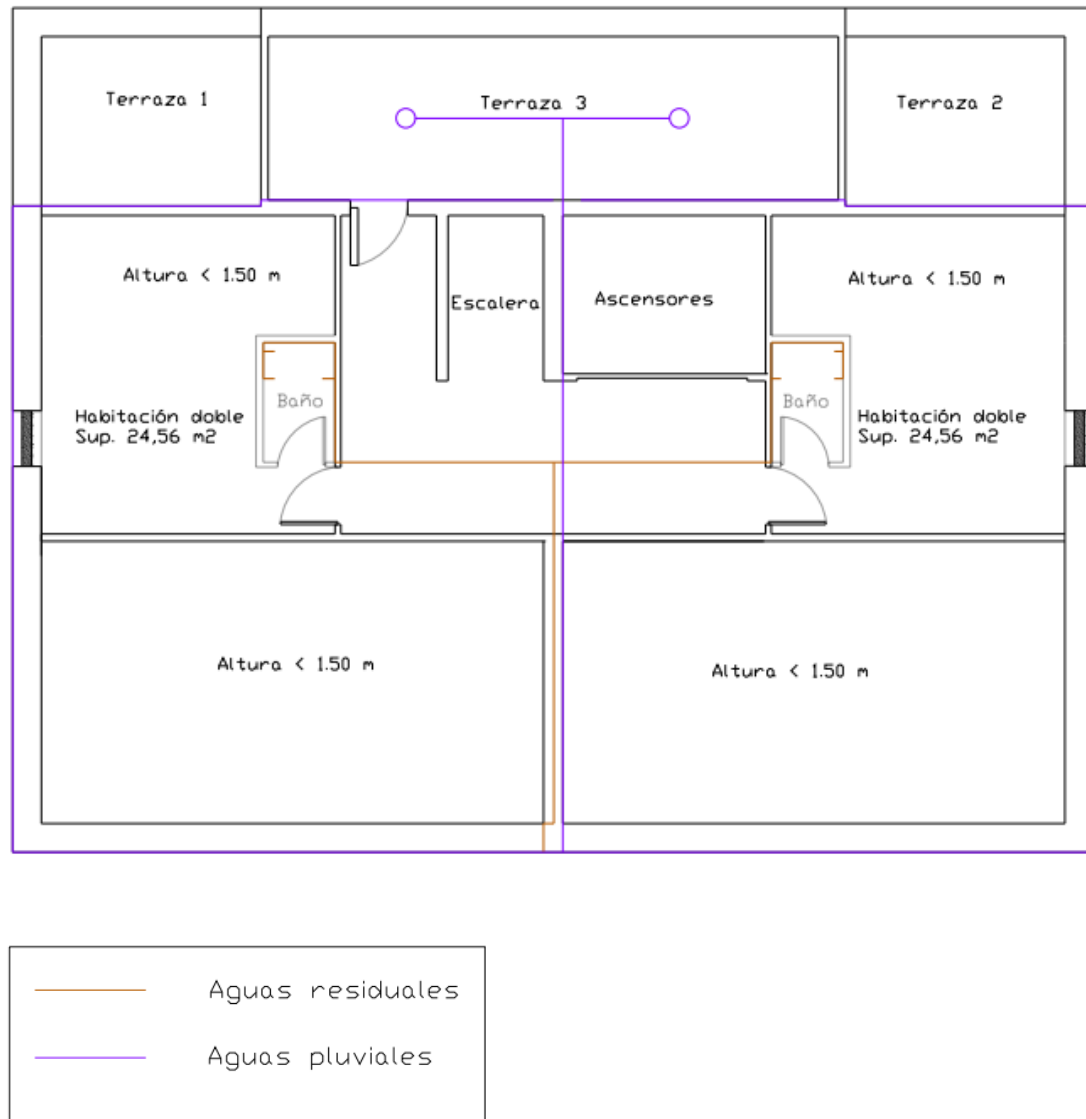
Red de evacuación de aguas en planta bajo cubierta. Fuente: Elaboración propia
